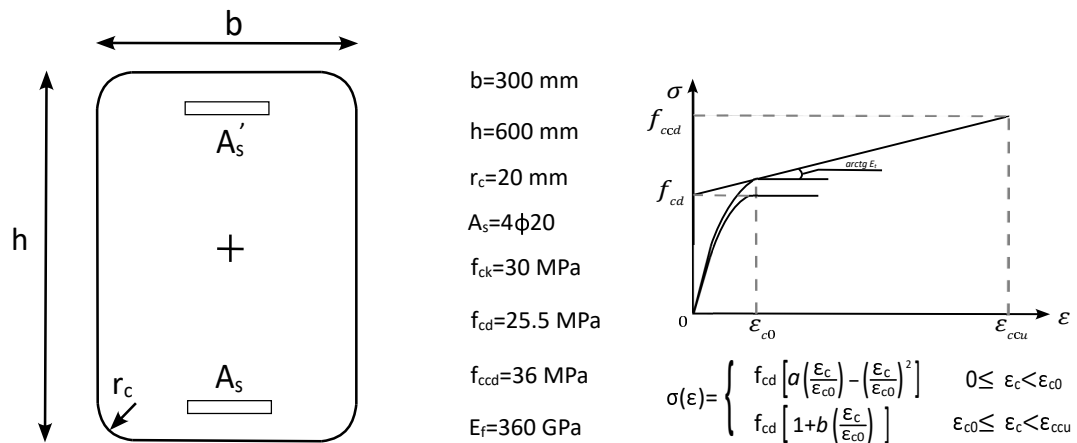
Sezione rettangolare in c.a. confinata con FRP soggetta a pressoflessione, caratteristiche geometriche e meccaniche
